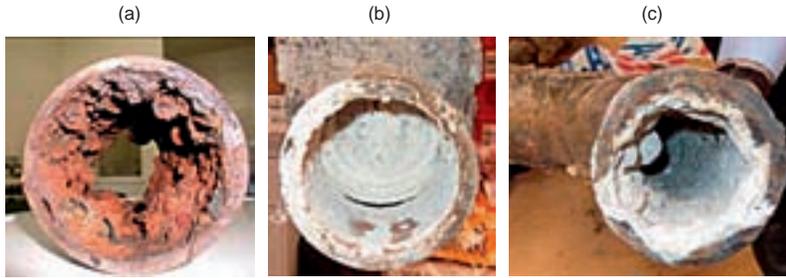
Exemplos de incrustação em condutas de materiais metálicos:
